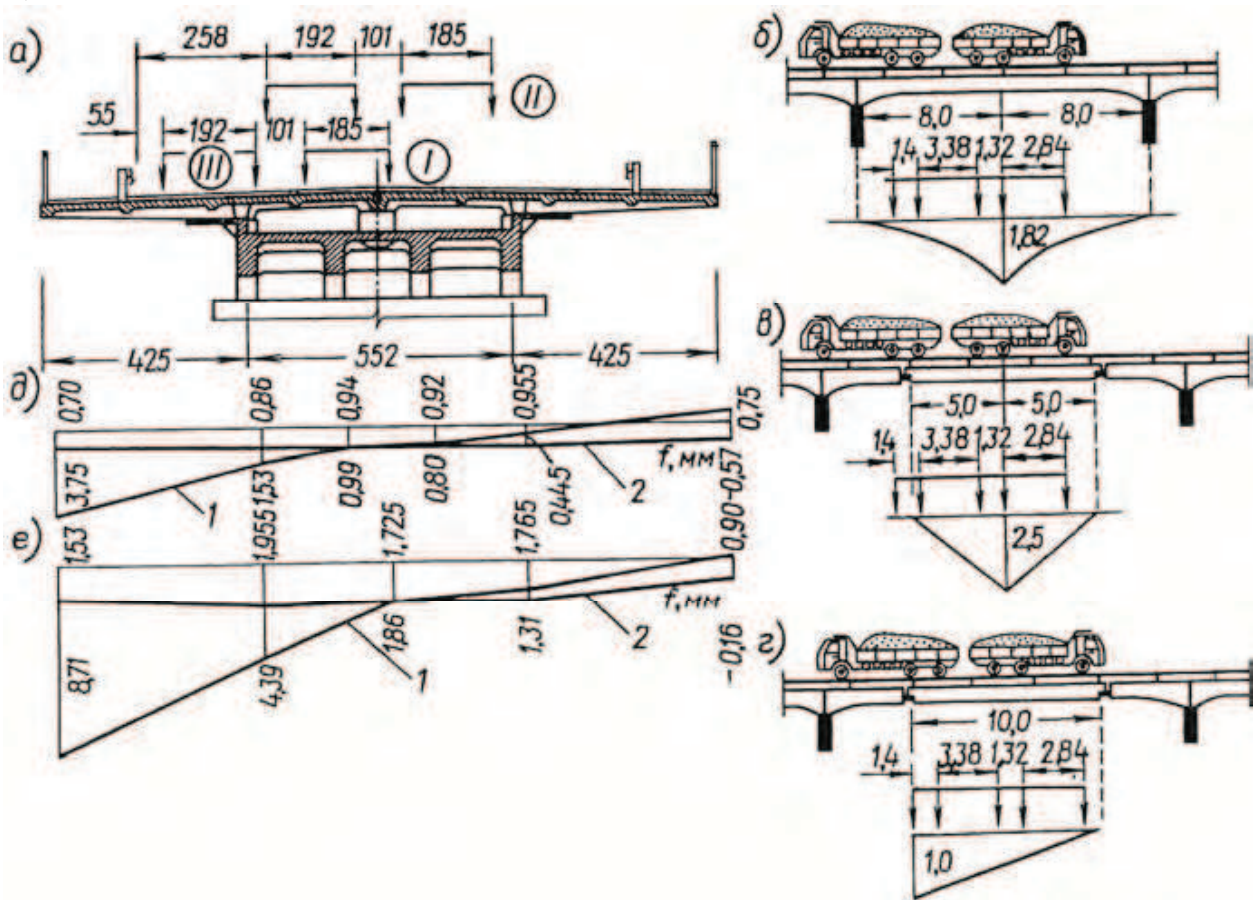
Схеми навантаження прольотних будов моста упоперек (а) і уздовж (б, в, г) прольотів. Епюри прогинів балок (д, е) при різних схемах навантаження
